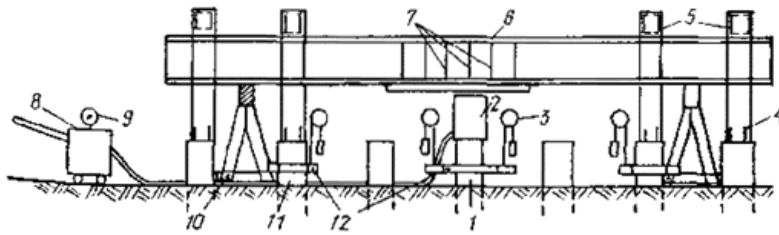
Схема испытания свай статической нагрузкой при однорядном расположении
